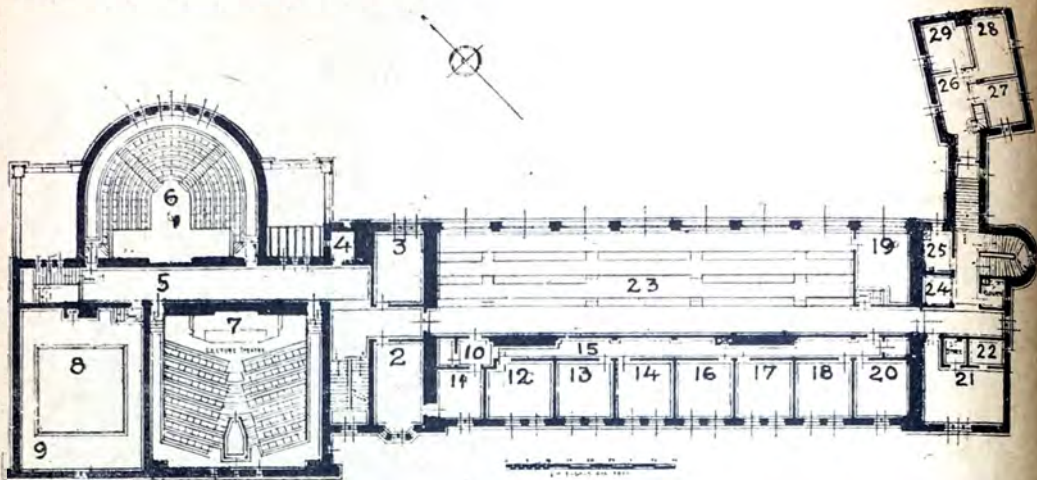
PLANTA DEL SEGUNDO PISO.
